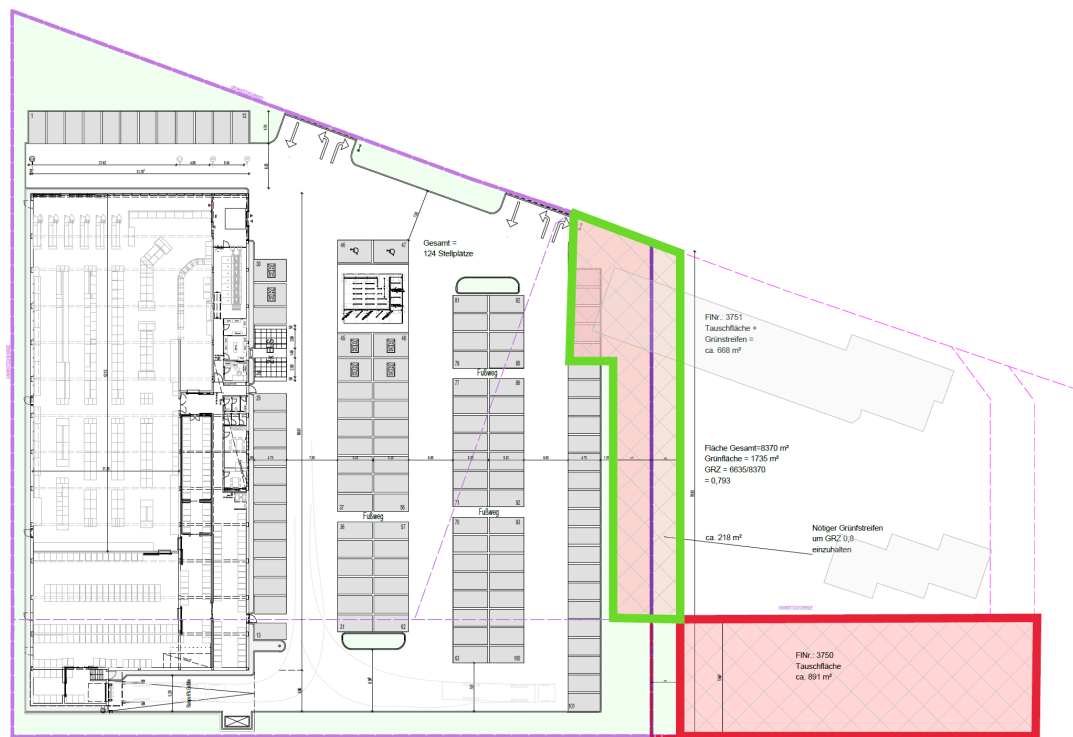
Planentwurf des neu zu errichtenden Gebäudes und der Parkplätze (Quelle: Kehrach Planwerk GmbH & Co. KG, Stand: 21.07.21)
